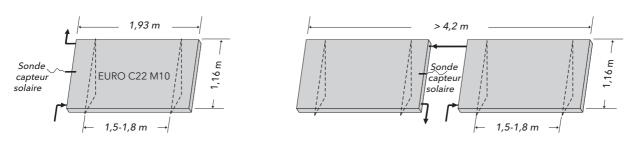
Possibilités de raccordement lors du montage sur toiture et sur châssis avec points d'ancrages sur la toiture et positions des sondes de température.
